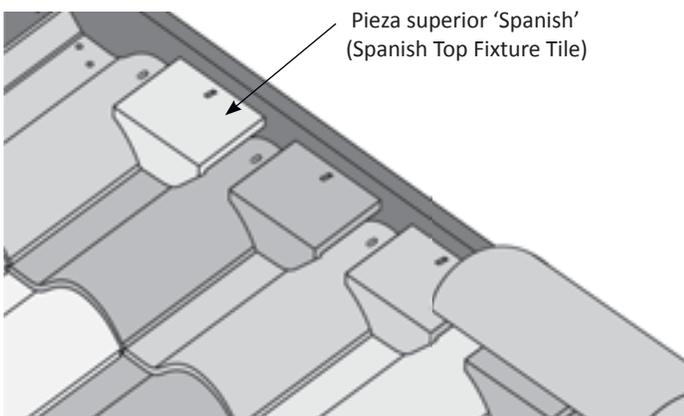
Detalle de pieza superior 'Spanish' (Spanish Top Fixture)
